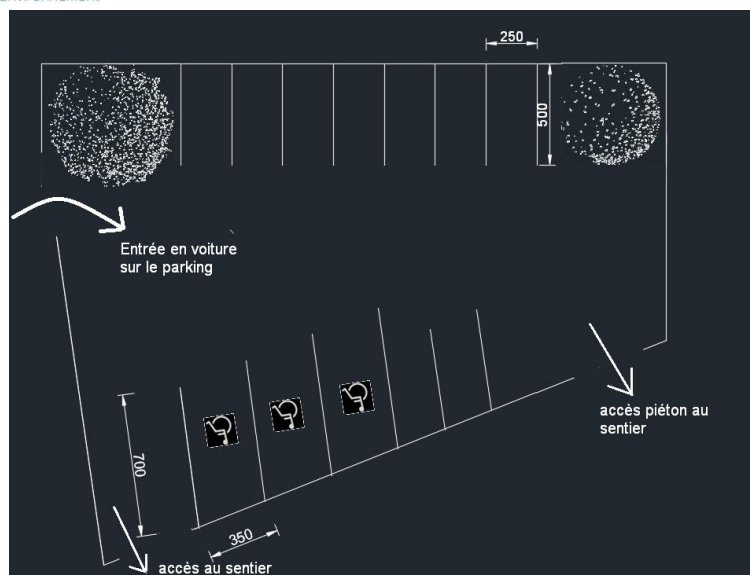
Plan AUTOCAD du parking nord offrant des places pour les P.M.R (DALIDO Chloé)
